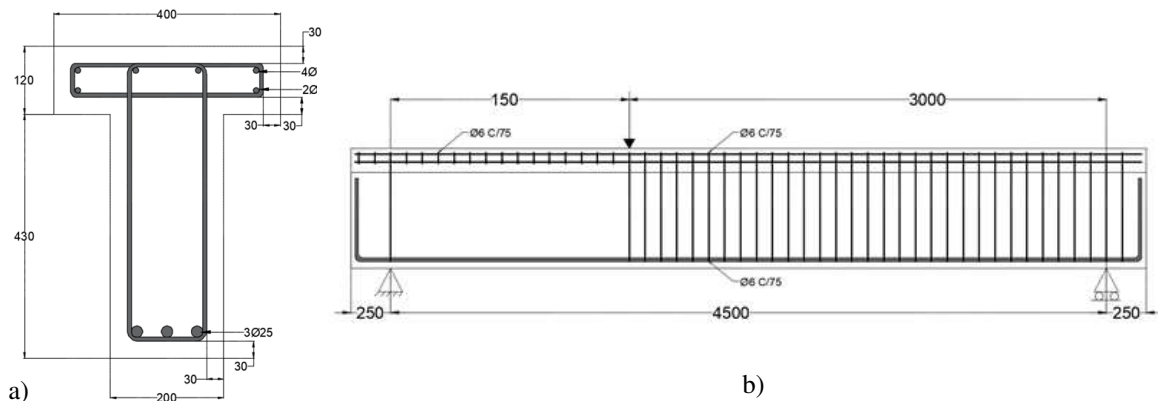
Vigas de HRF armado ensayadas a corte (medidas en mm). a) Sección transversal; b) Vista longitudinal
